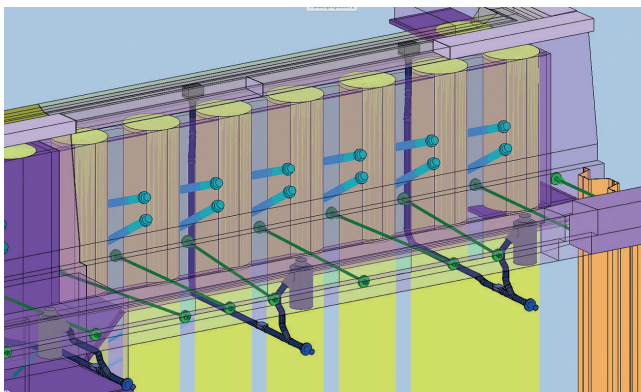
Ausschnitt aus dem 3D-Planungsmodell, hier: Kollisionsprüfung Horizontalanker und Entwässerung *Grafik: WKC
